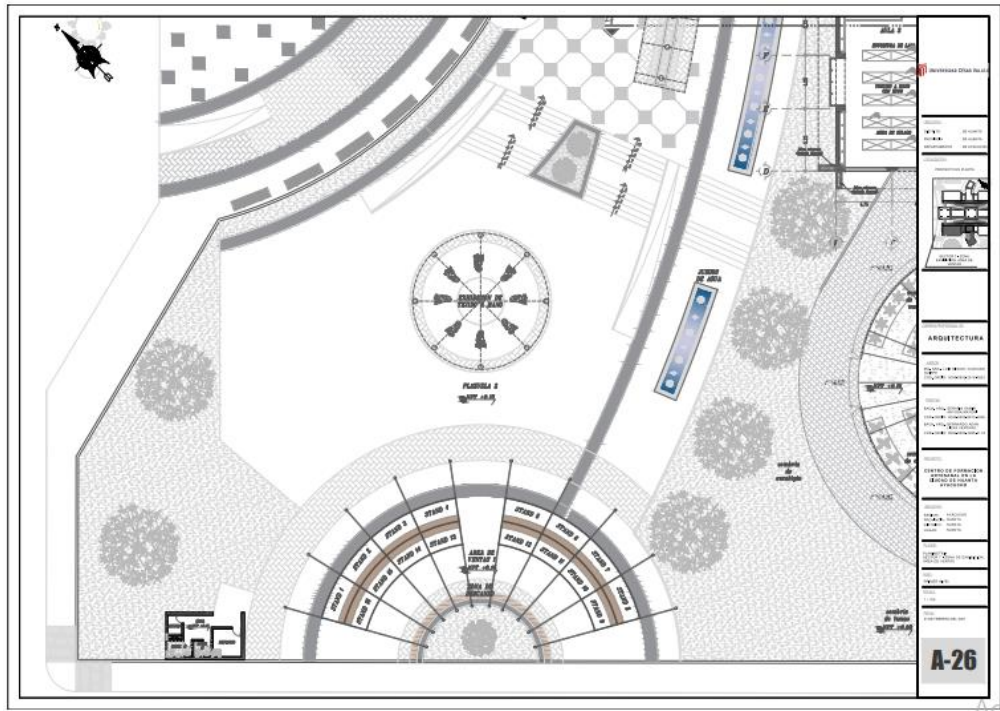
Planimetría del sector 7 ubicado en el piso 1. Escala 1/100.
